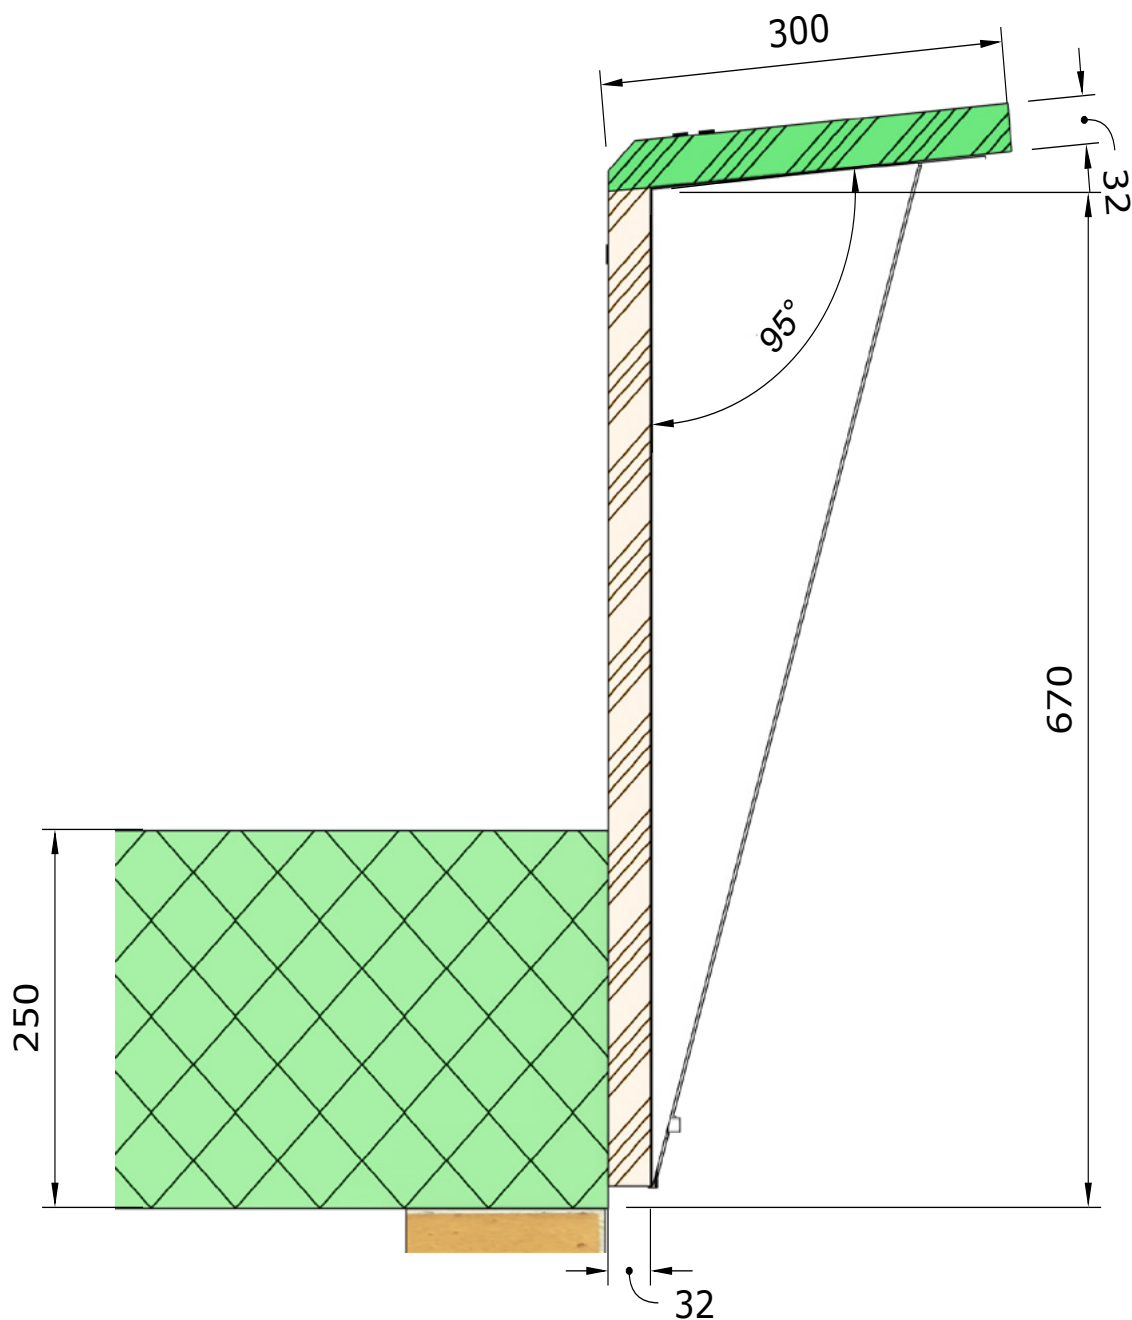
Vue en coupe, structure de l'acrotère entièrement accessible avec tôles de support et lambourdes en bois massif entre les tôles de support.
